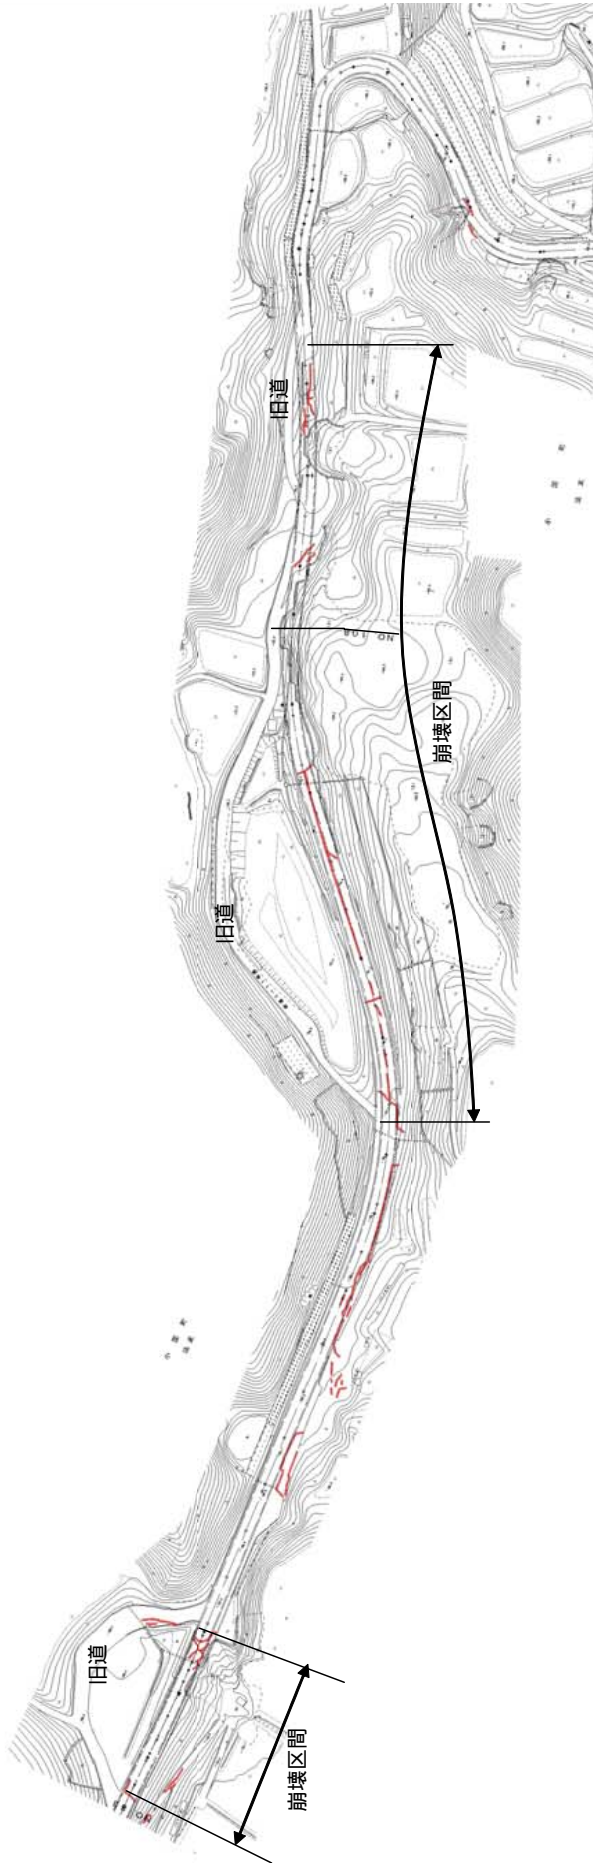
崩壊箇所周辺の平面図（小国町法末）
